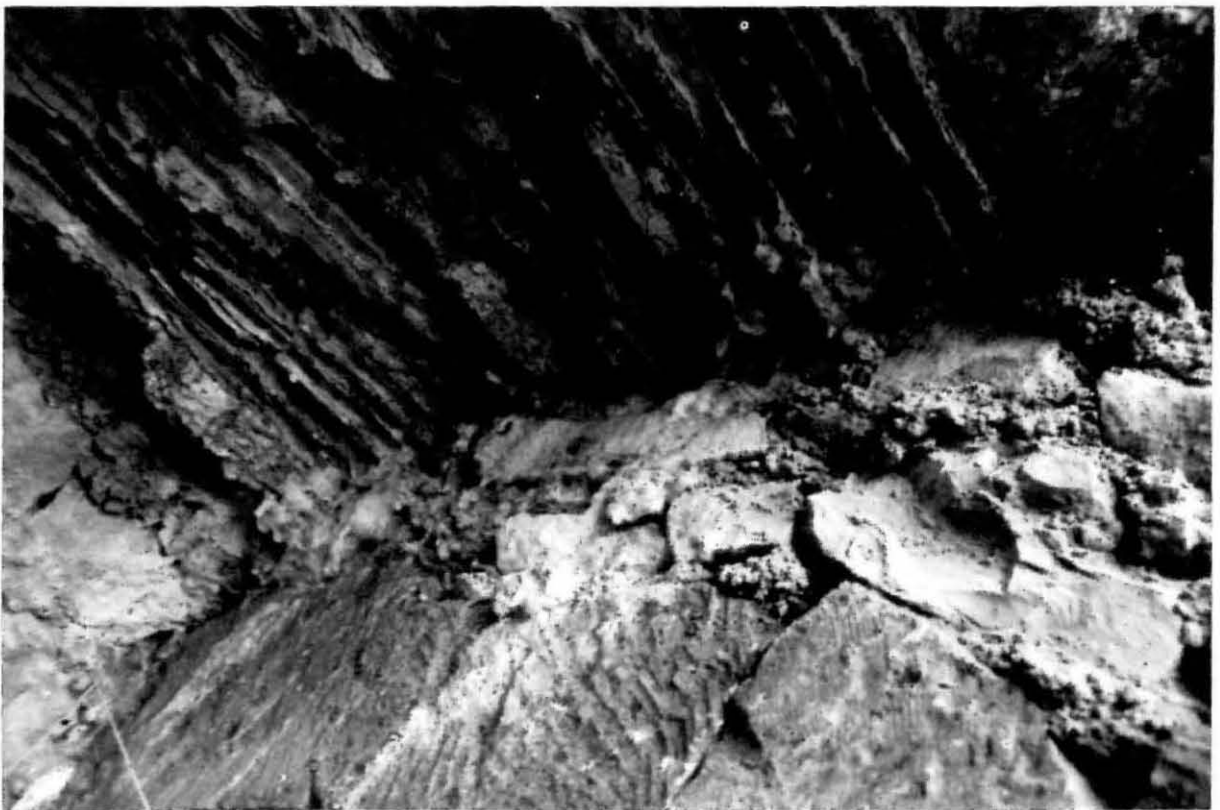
Detall de les empremtes deixades en el morter per la cimbra de canya usada en la construcció de la volta (foto Enfoc).
